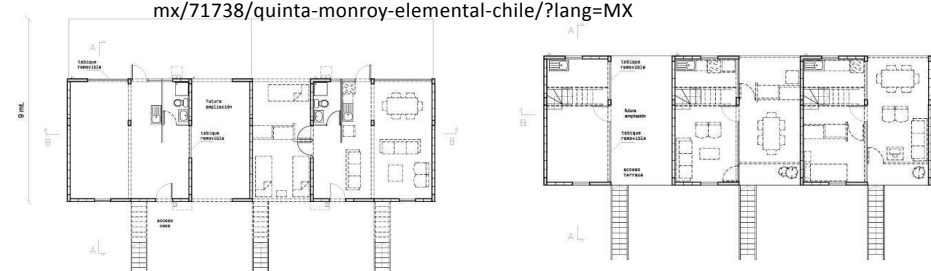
Planta Arquitectónica baja y Alta S/E Fuente: <http://www.archdaily.mx/71738/quinta-monroy-elemental-chile/?lang=MX>
